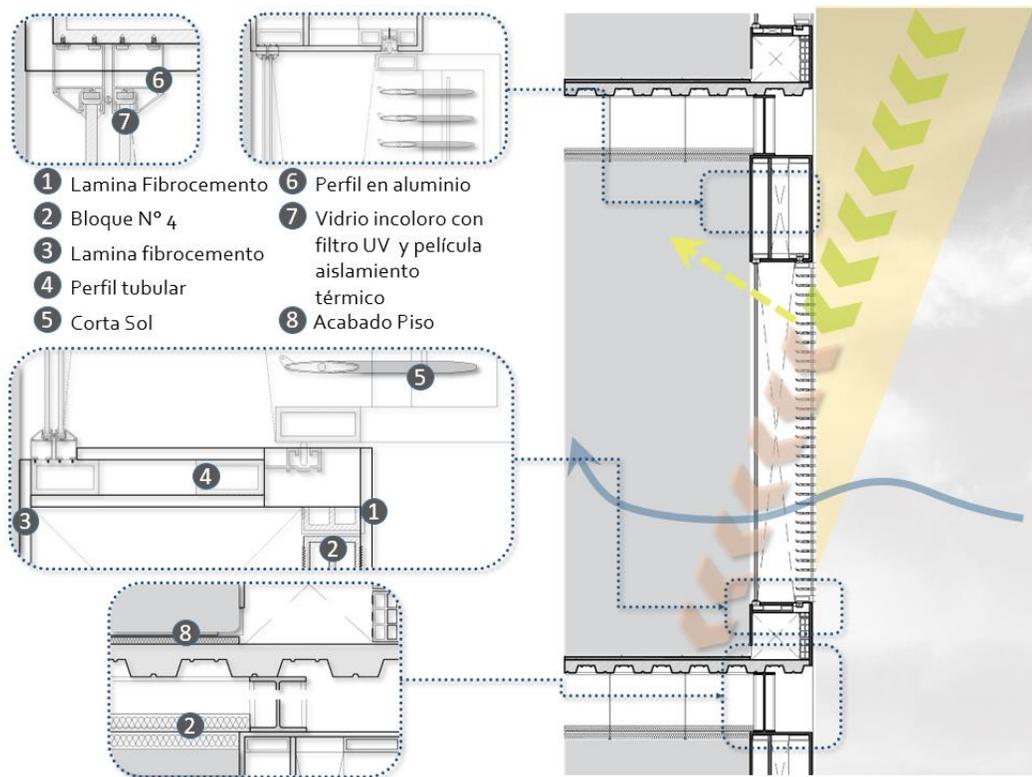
Corte fachada y detalles correspondientes a materialidad en clima templado (ver anexo – “Detalle corte fachada”)
